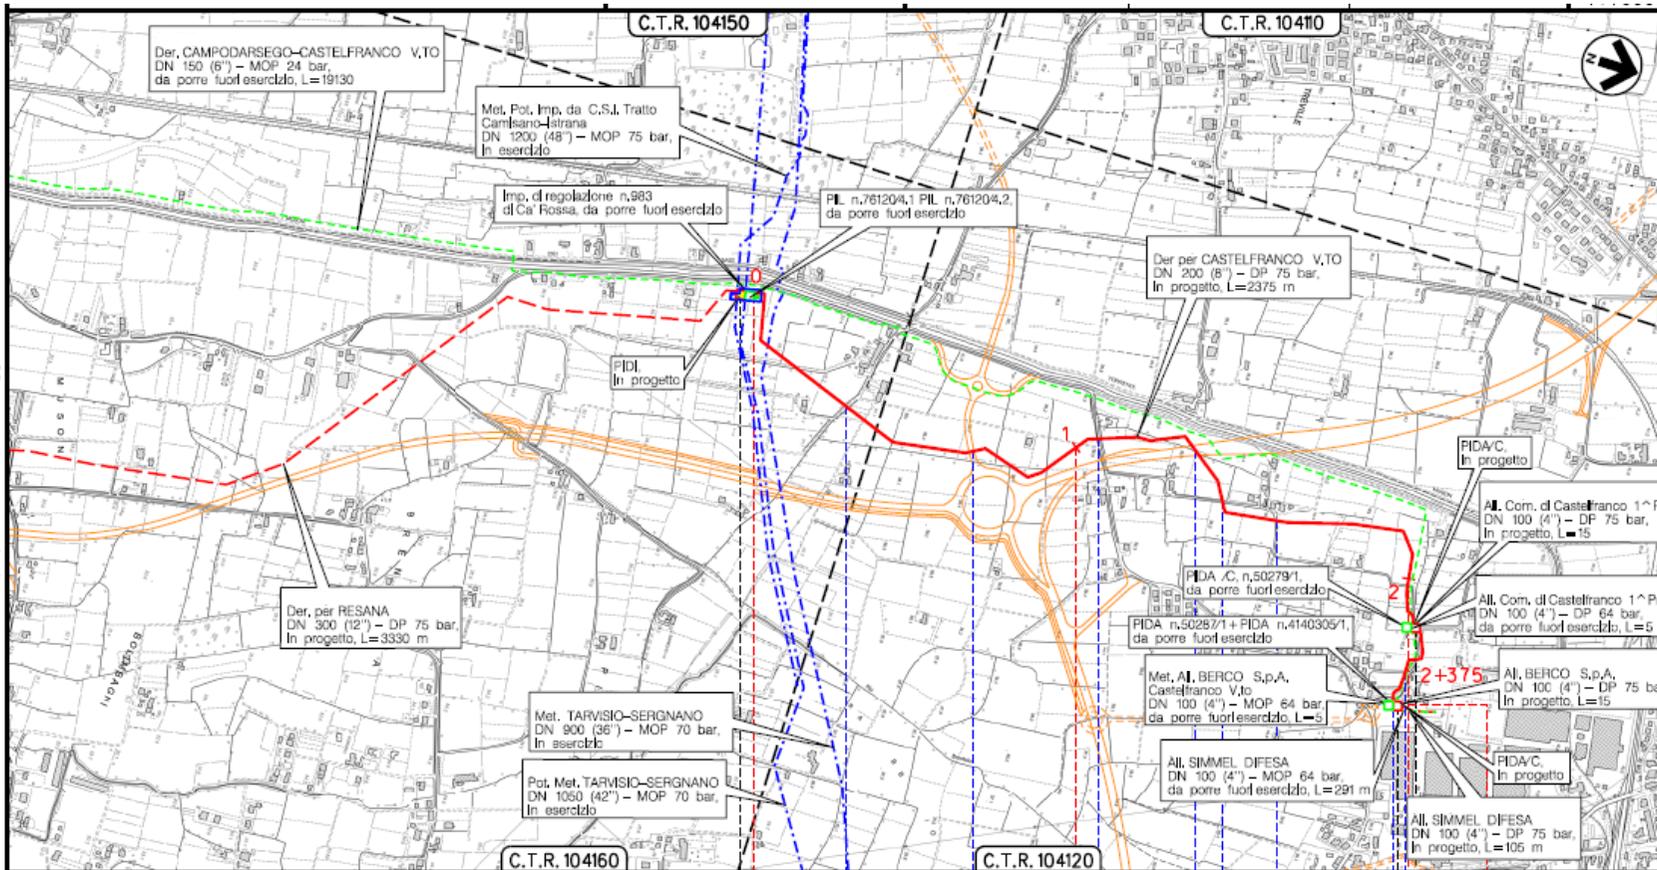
2^a TRATTO - Stralcio planimetria CTR con localizzazione dell'area di intervento
